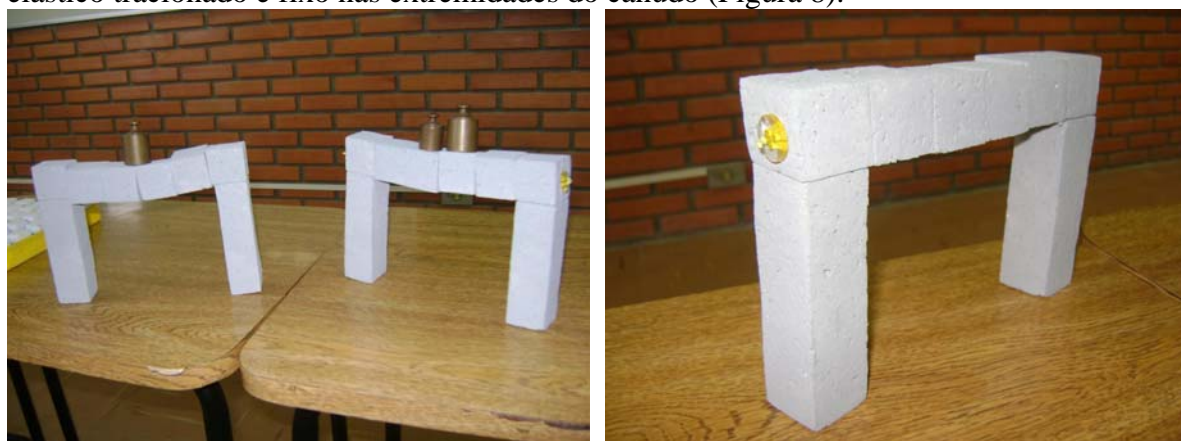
Modelos de vigas bi-apoiadas simulando concreto armado e protendido.
